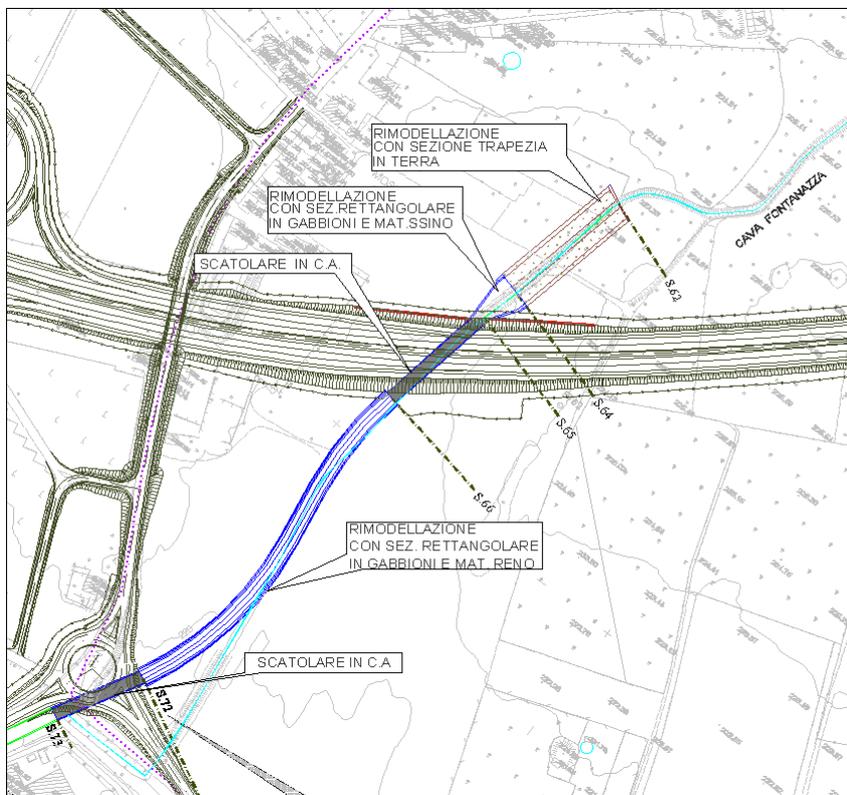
Prog. Definitivo- Modellazione Cava Fontanazza, stralcio planimetrico del progetto
